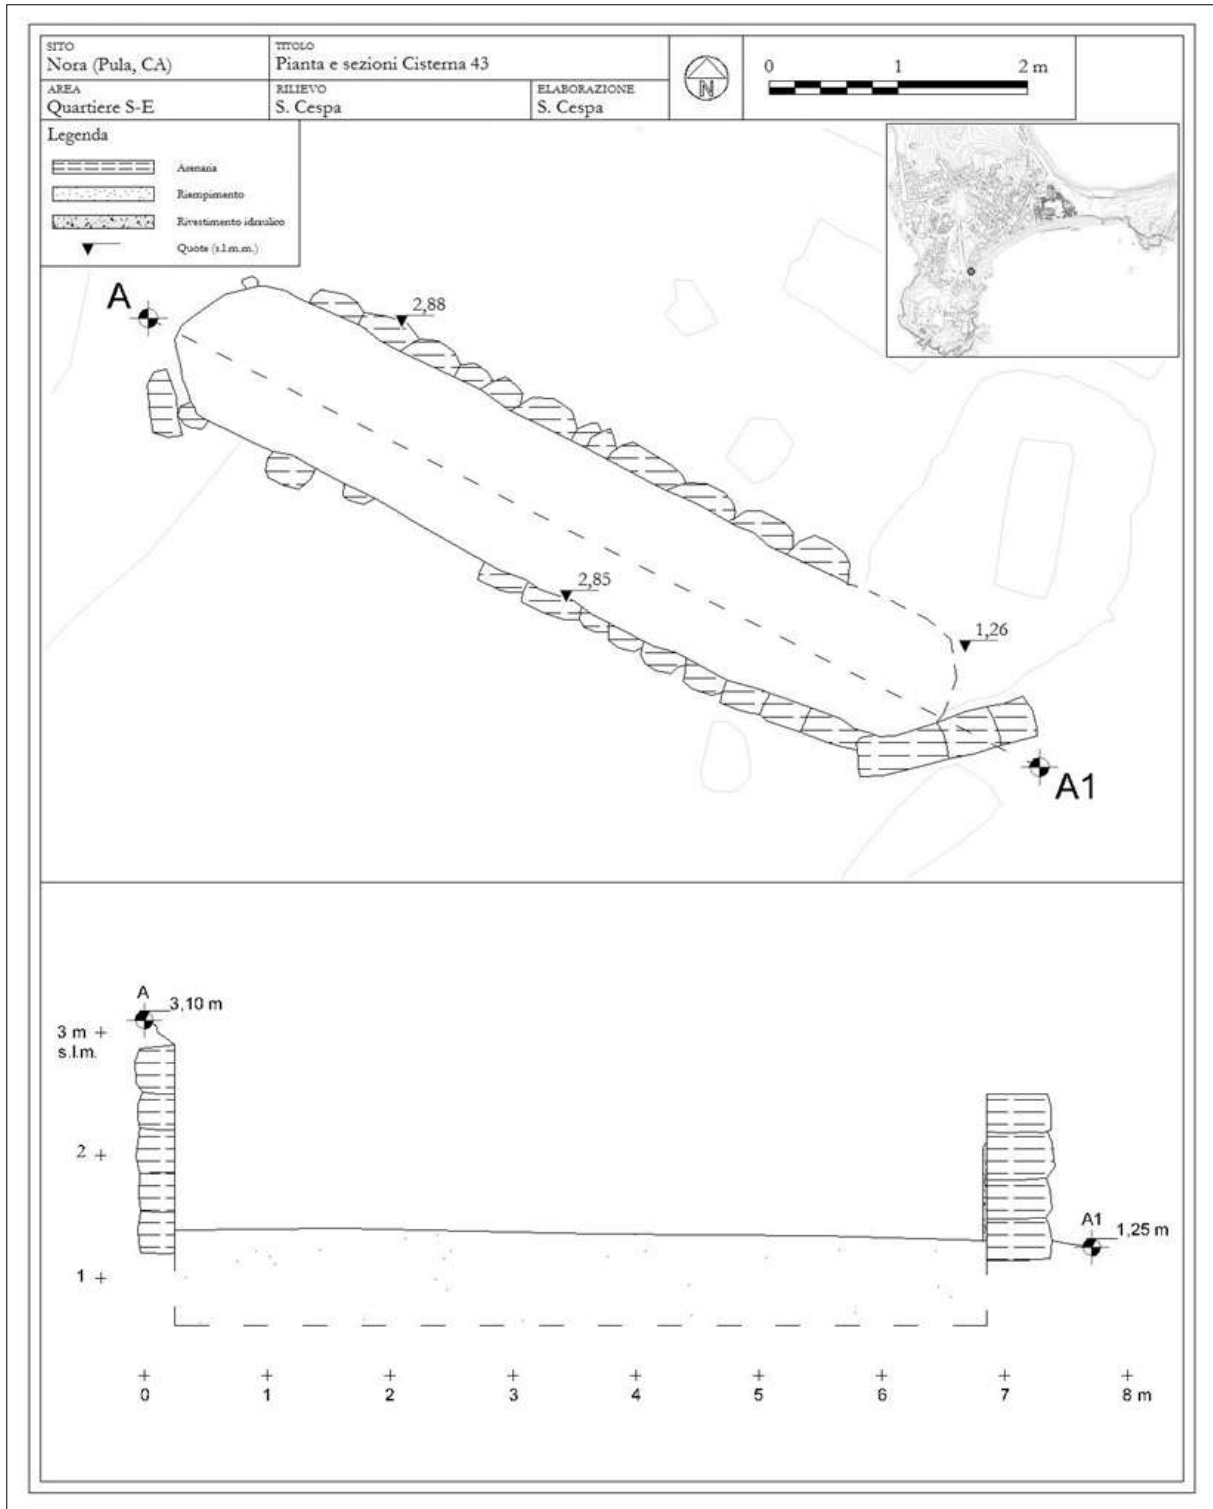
Pianta e sezione della cisterna 43 (elaborazione dell'autore).
